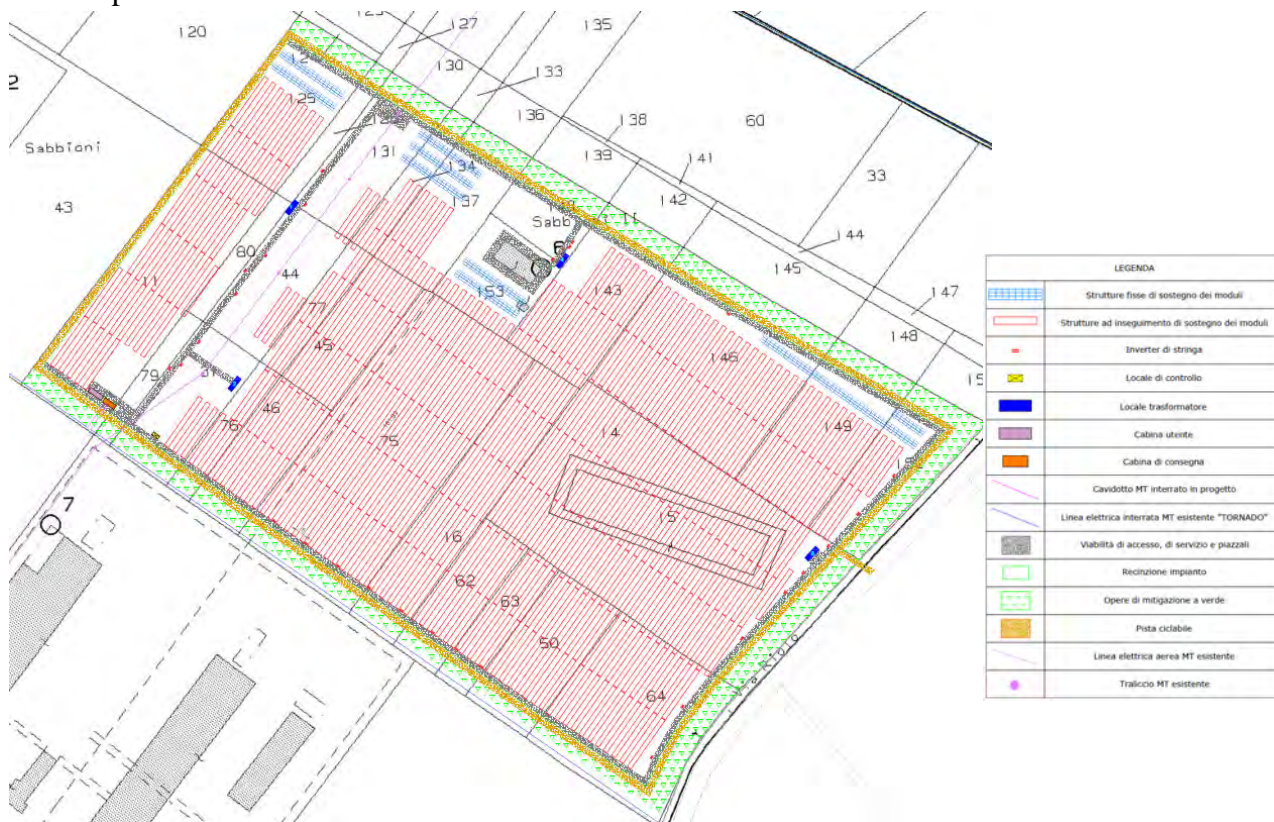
Planimetria generale impianto fotovoltaico “Sant’Agostino”
